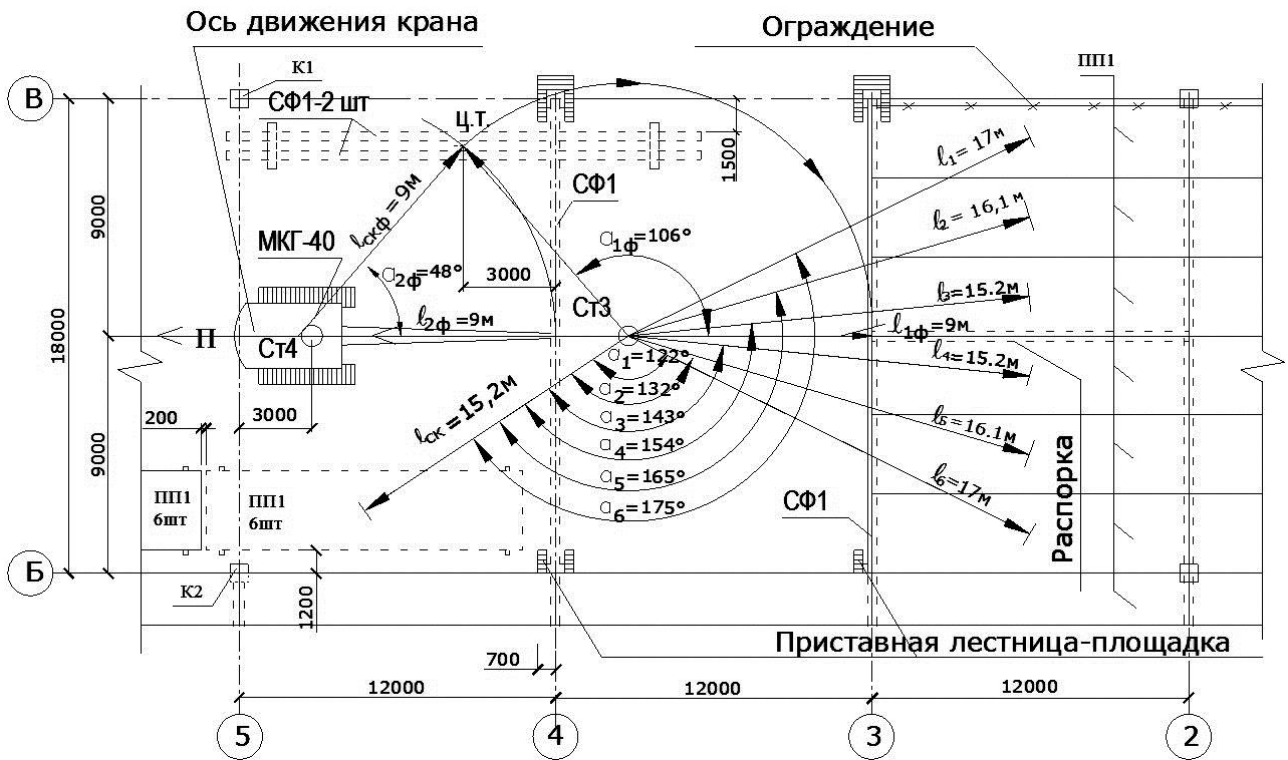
Схема монтажа железобетонных конструкций покрытия при пролете 18 м
